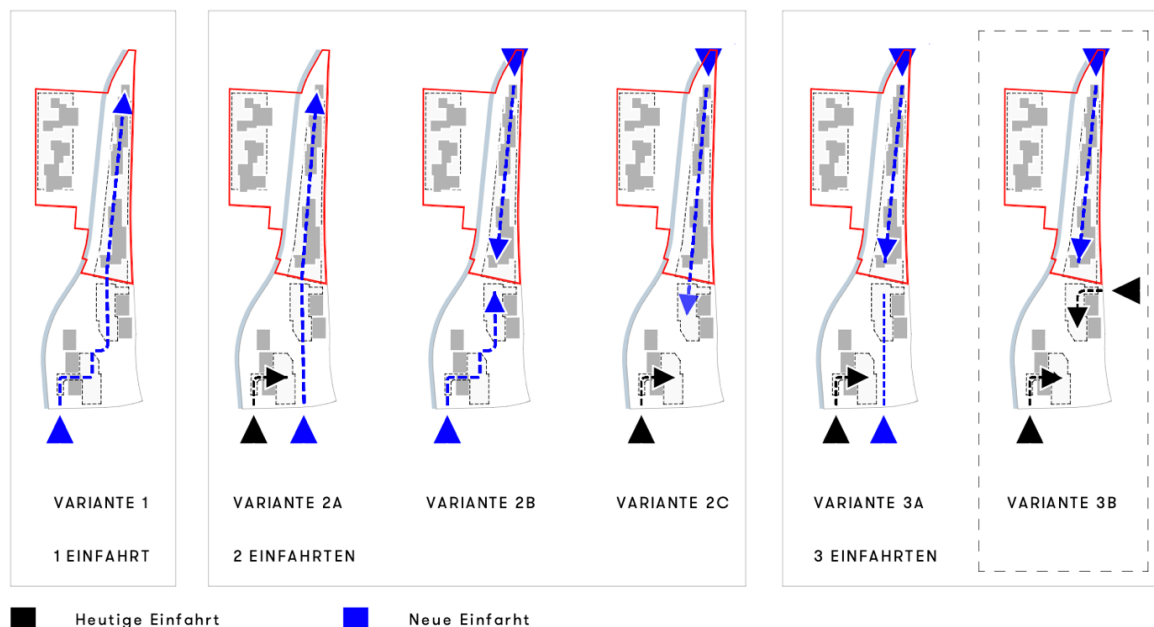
Erschliessungsvarianten Autoeinstellhalle
